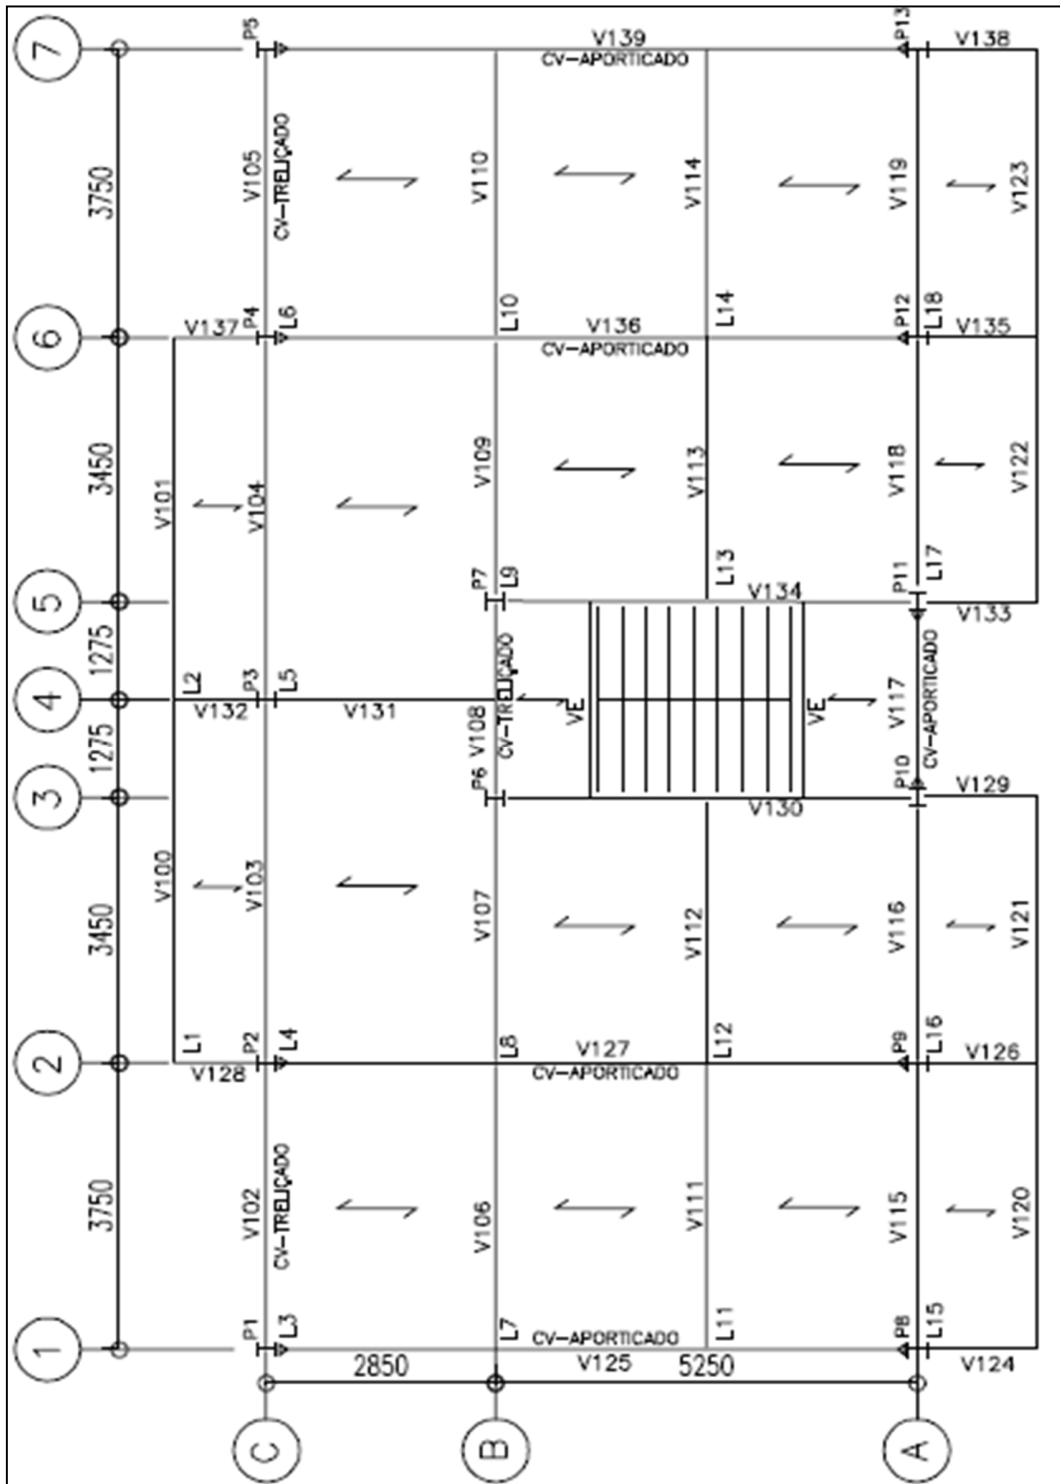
Direções das nervuras dos steel decks no plano das vigas (El. +3500 @ +10500)
